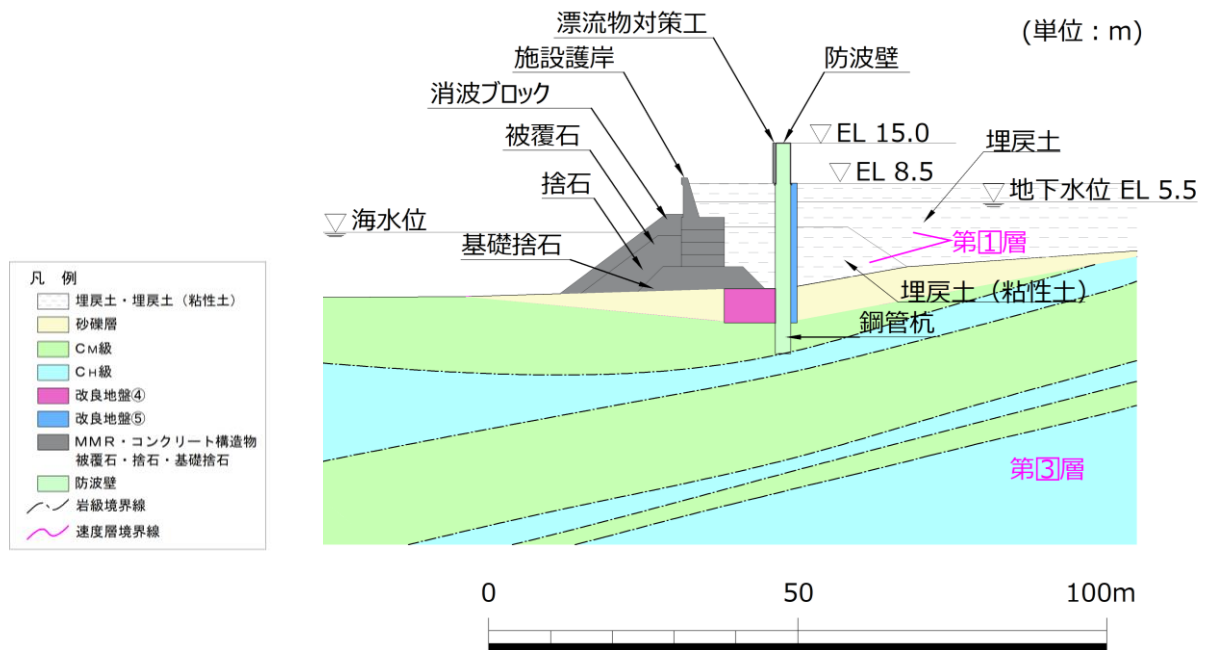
砂礫層の配置図 (②-②断面)
